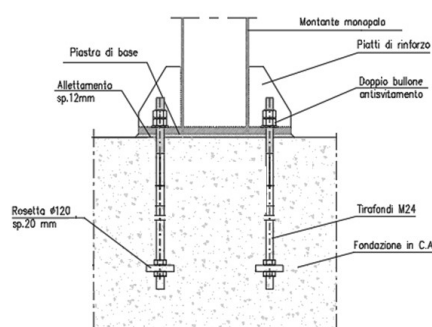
Caratteristiche dell'ancoraggio alla fondazione
